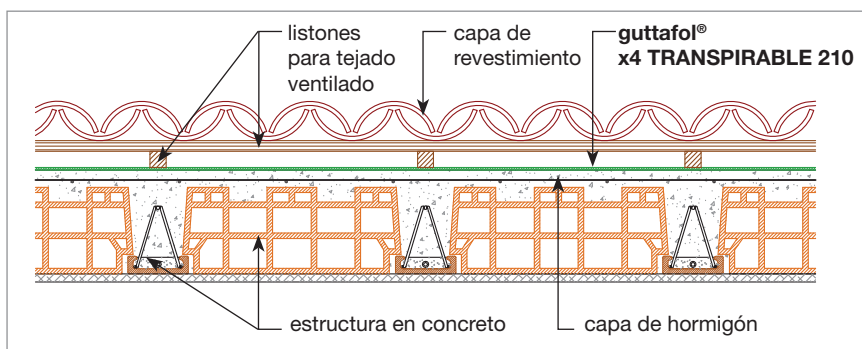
guttafol® x4 TRANSPIRABLE 210 colocado directamente sobre la capa de hormigón con cámara de ventilación
